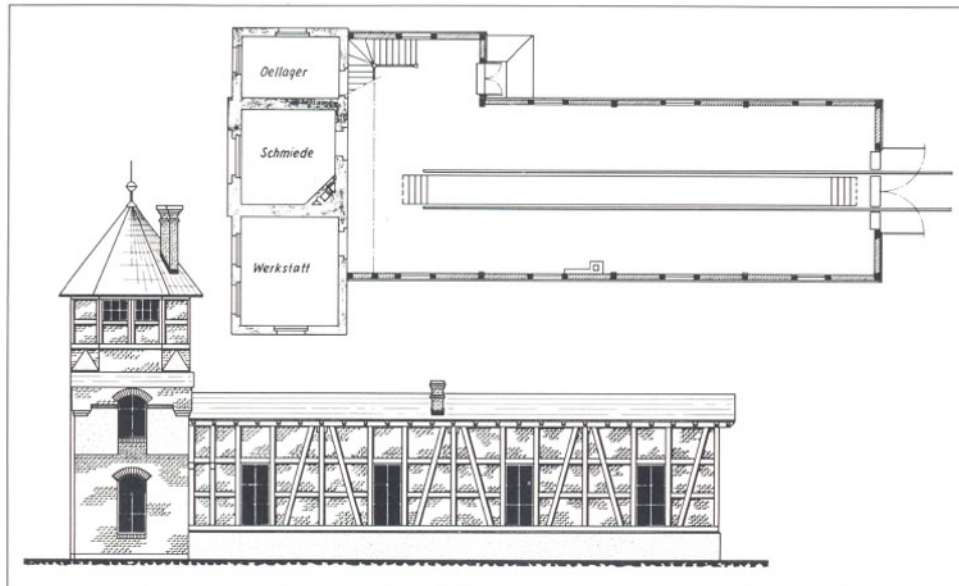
Grundriß und Seitenansicht des 26,5 m langen Schuppens vor dem Umbau. Maßstab der Zeichnung: etwa 1:300. Zeichnung: C. G. Zillmer
